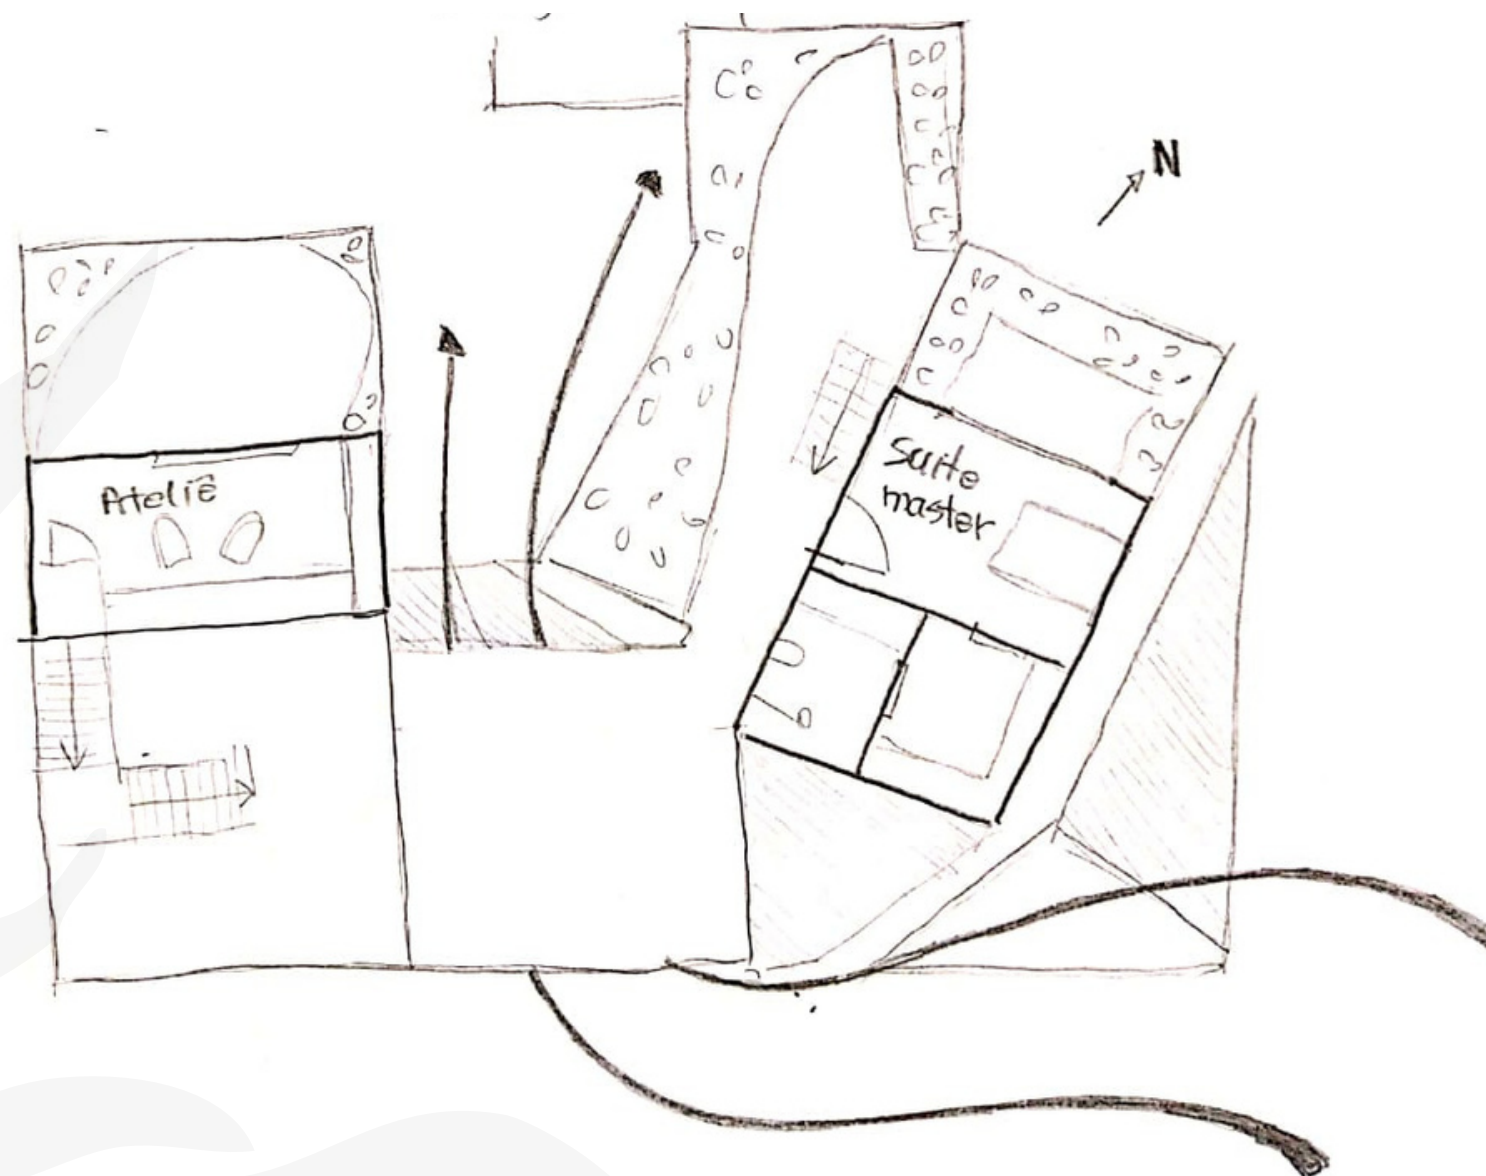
Planta baixa em croqui. Primeiro Pavimento. Fonte: Elaboração própria da autora.
